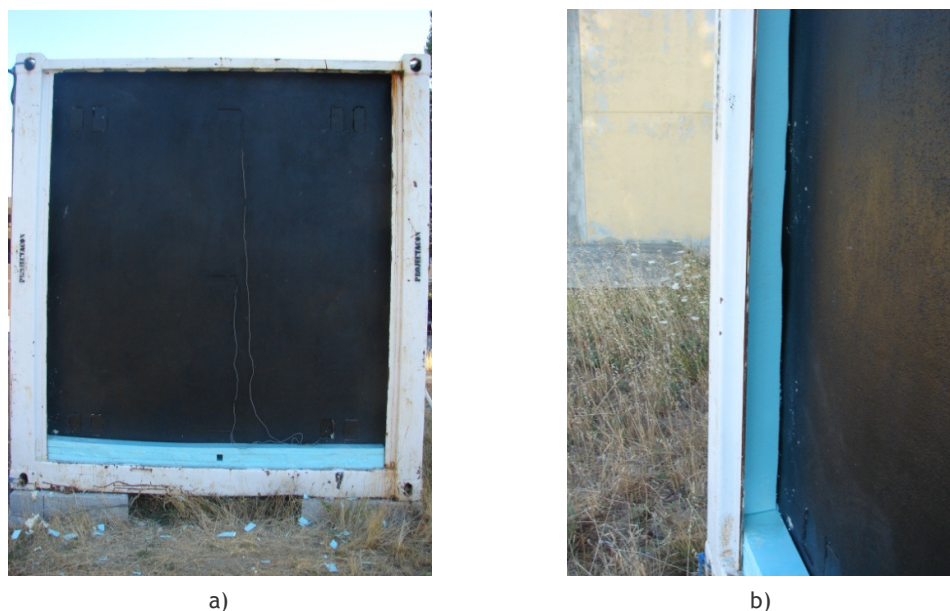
Isolamento térmico em XPS da envolvente da caixa-de-ar: a) pavimento; b) parede.
